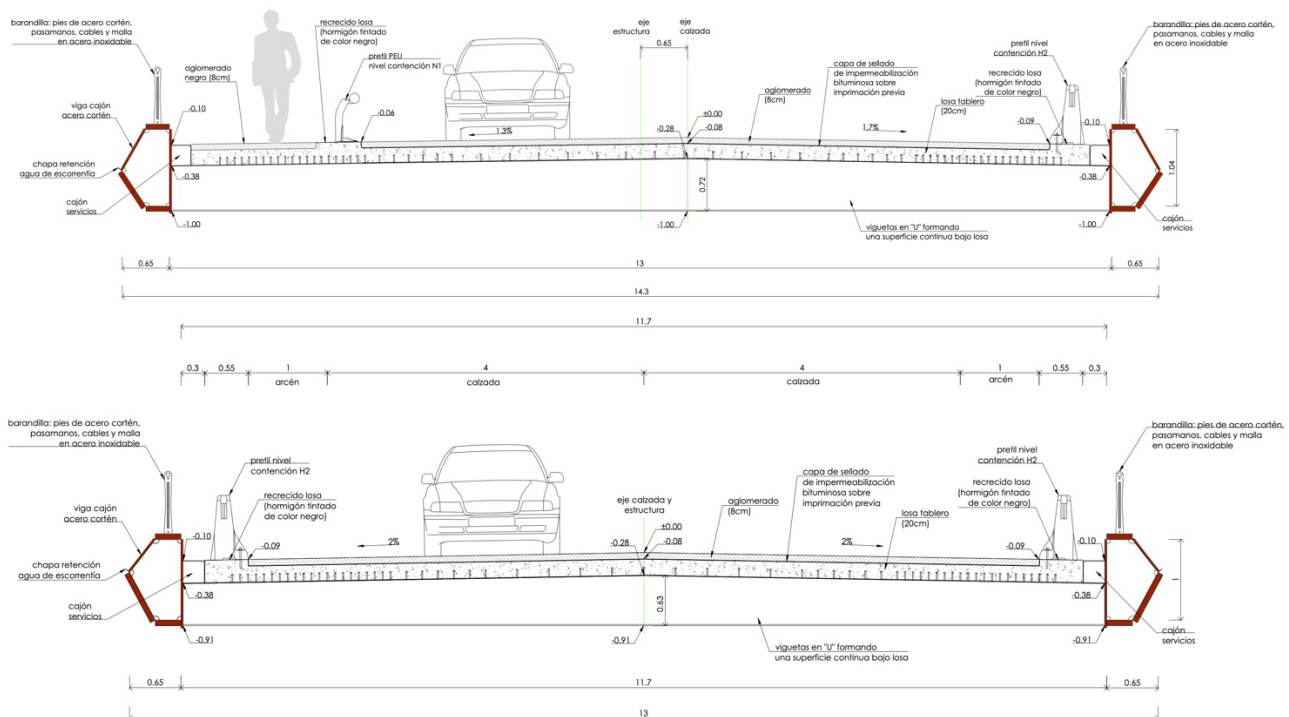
Sección transversal del puente Norte (arriba) y el puente Sur (abajo)
